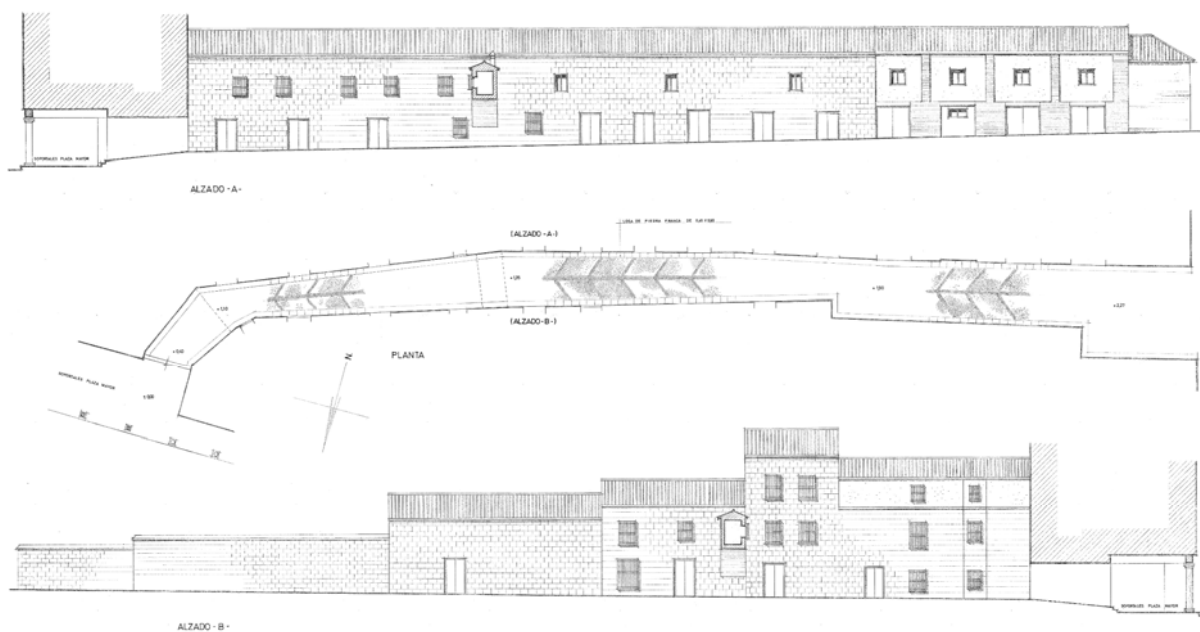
Planta y alzados. *Proyecto de restauración del recinto de la Barbacana.* AELL, expediente nº 277, planos 16LL/izq caja 9.
